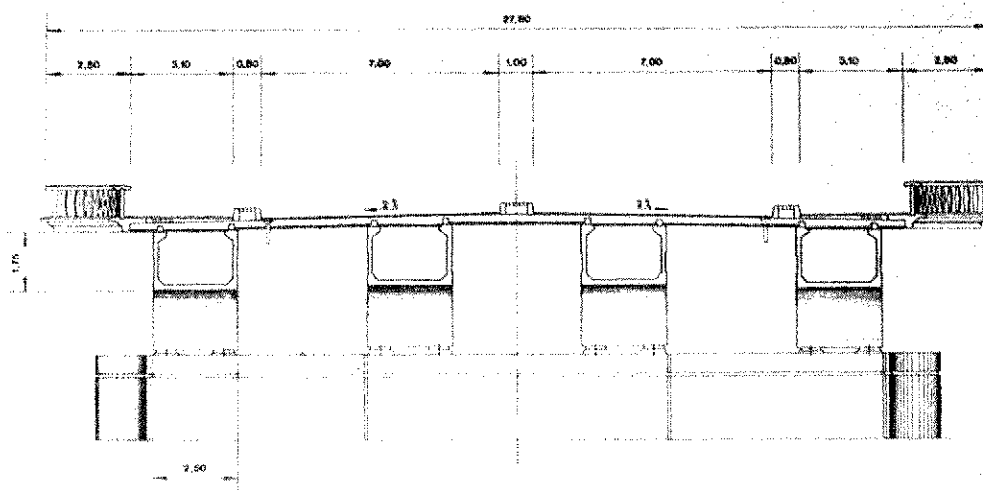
Puente de tablero continuo y sección variable. Sección transversal.
